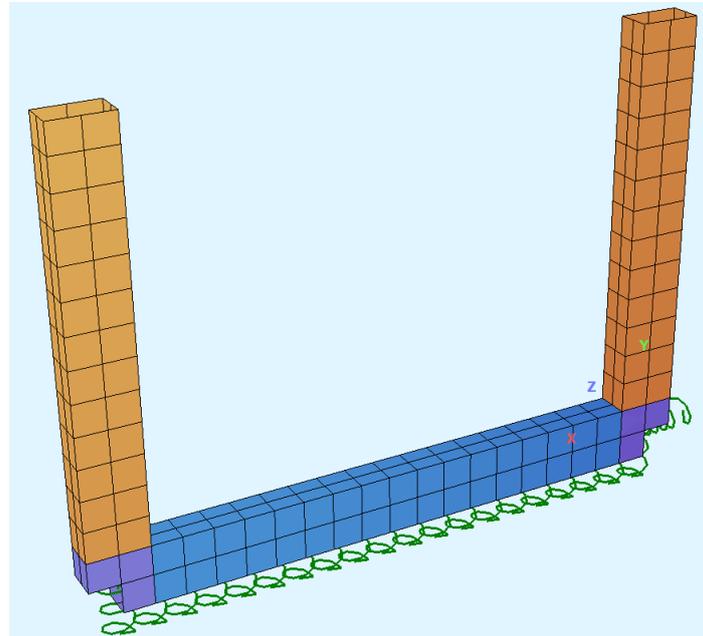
Sezione trasversale muro ad U –vista 3D
